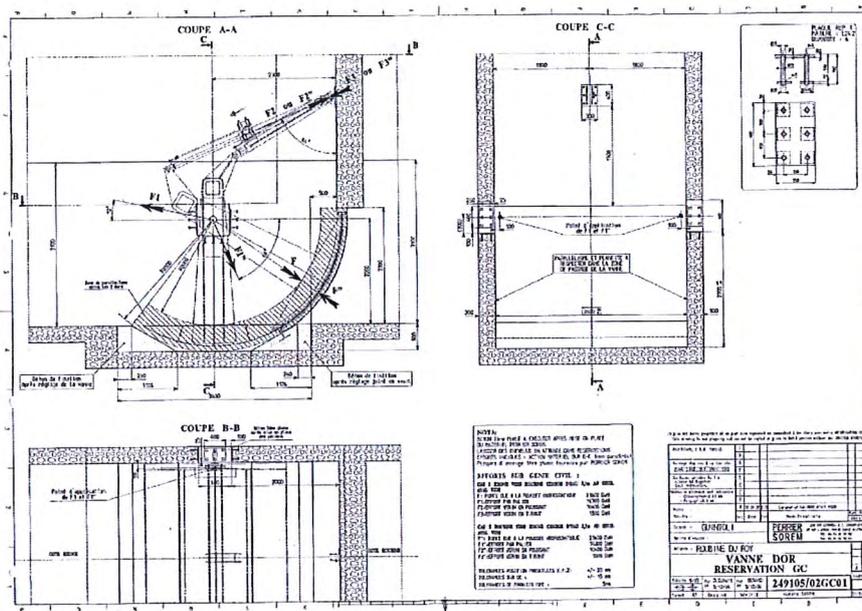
Plan de récolement de la vanne secteur de la roubine du Roy
